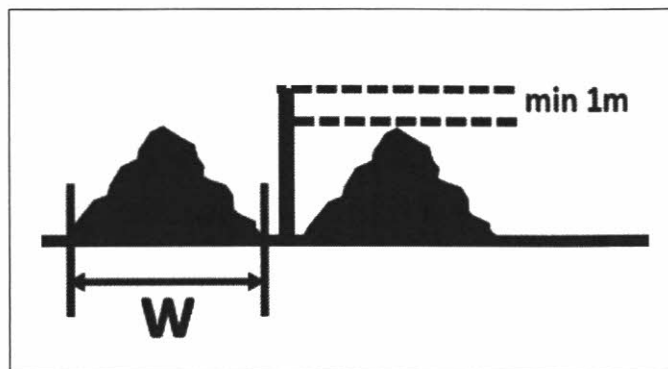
Illustrazione V.N°.5.3 - 1 : Esempio altezza minima della parete di separazione
